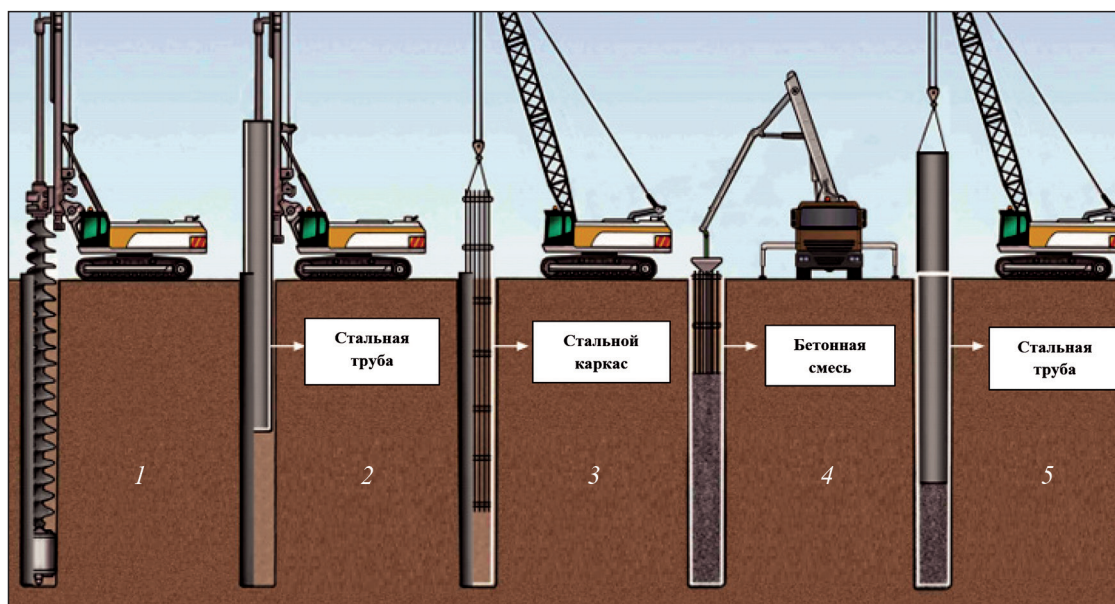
Технология изготовления свайного фундамента на строительной площадке: 1 — сверление отверстия; 2 — размещение внутри отверстия стальной трубы; 3 — размещение в трубе каркаса арматуры; 4 — заливка бетоном каркаса; 5 — извлечение трубы
